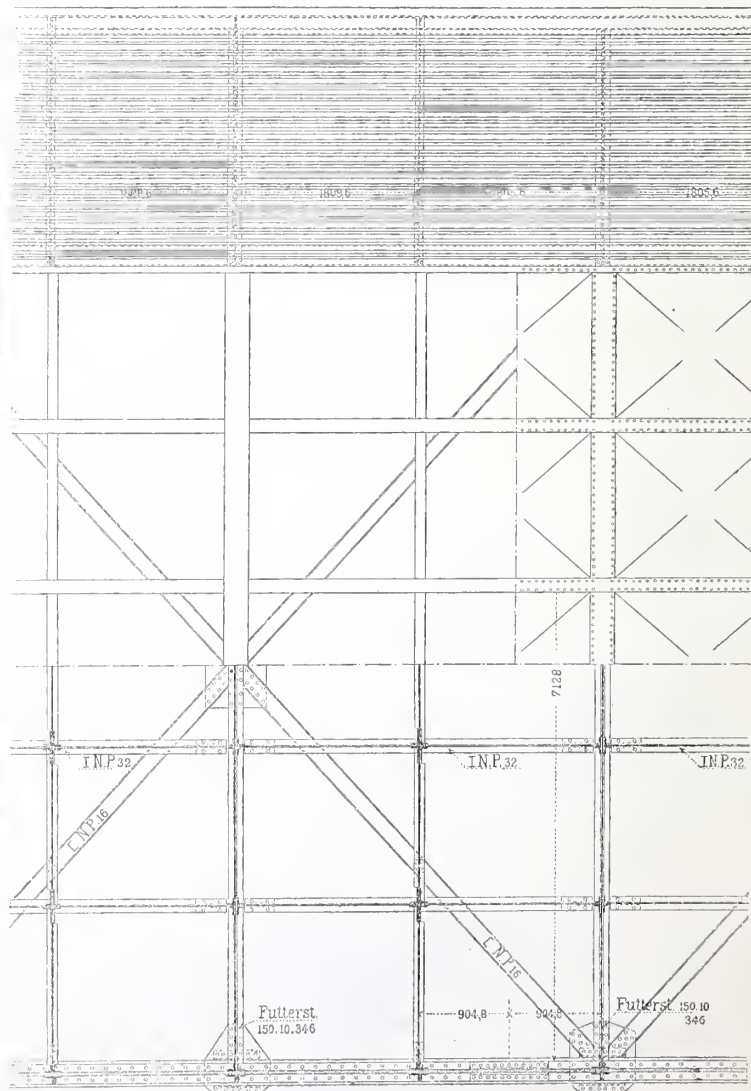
Grundriss der Fahrbahn 1:75.
